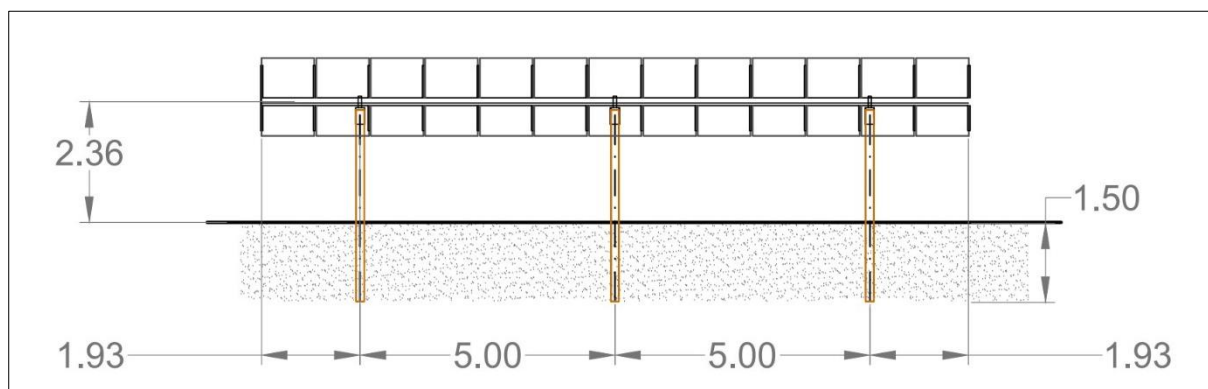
Stralcio prospetto struttura di supporto 2x13
